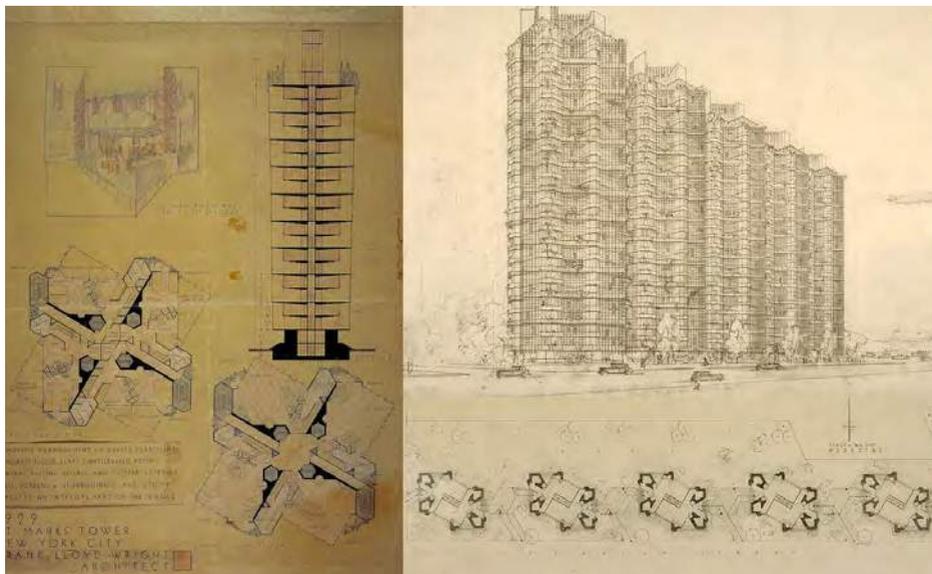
F.L.Wright: *St. Mark's-in-the-Bouwerie Tower, New York Project 1927-31; Piante, Sezione e Prospettiva di un appartamento su due piani, 1929; Grouped Towers, Chicago Project 1930 Prospettiva e pianta . The Frank Lloyd Wright Foundation Archives (The Museum of Modern Art | Avery Architectural & Fine Arts Library, Columbia University, New York)
